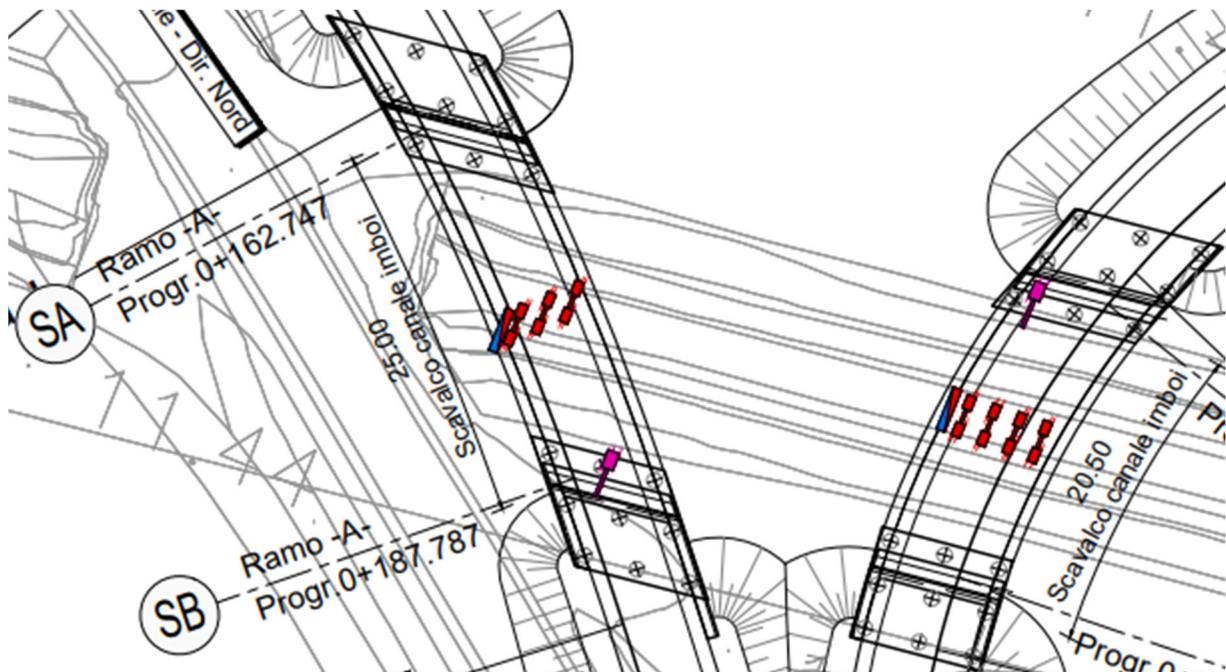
Ubicazione sensori su impalcato a 3 e 4 travi (Pianta impalcato VI04-VI05)
